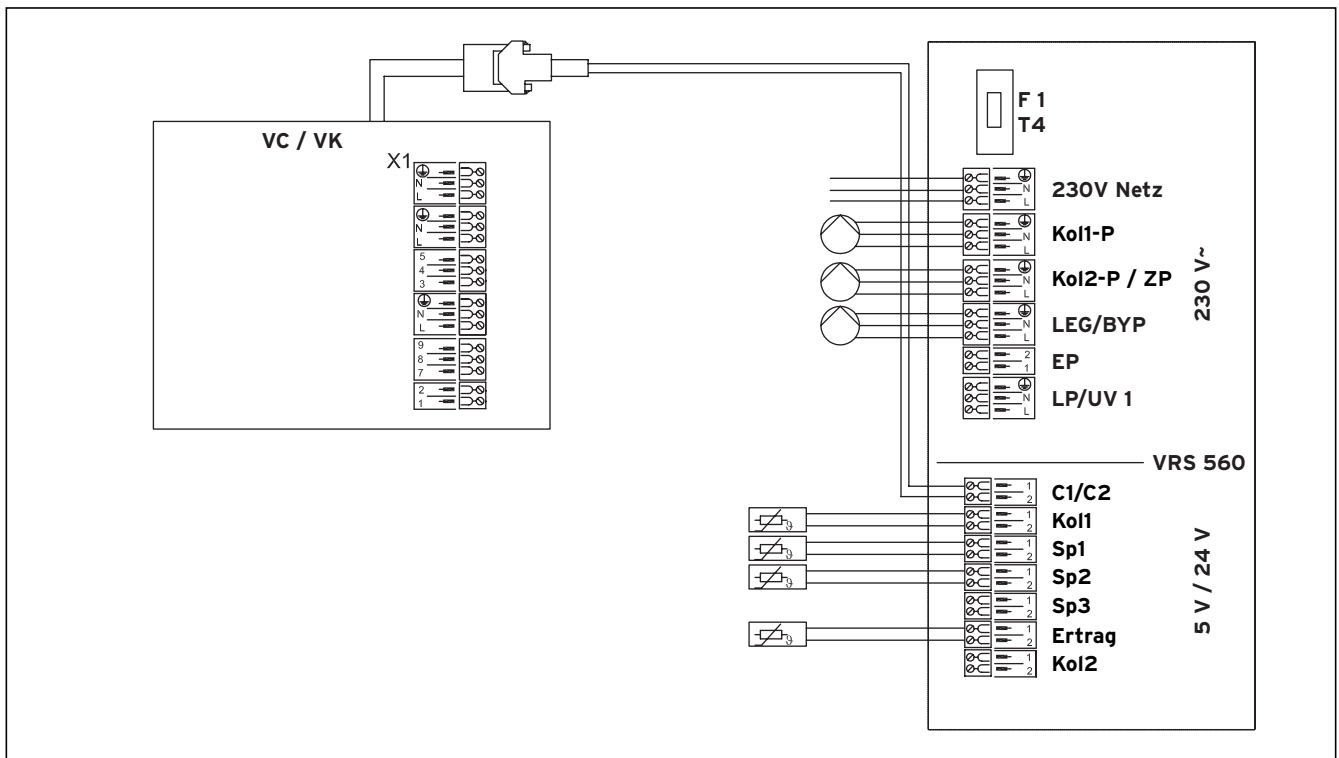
Anschlussplan für Hydraulikplan 1
